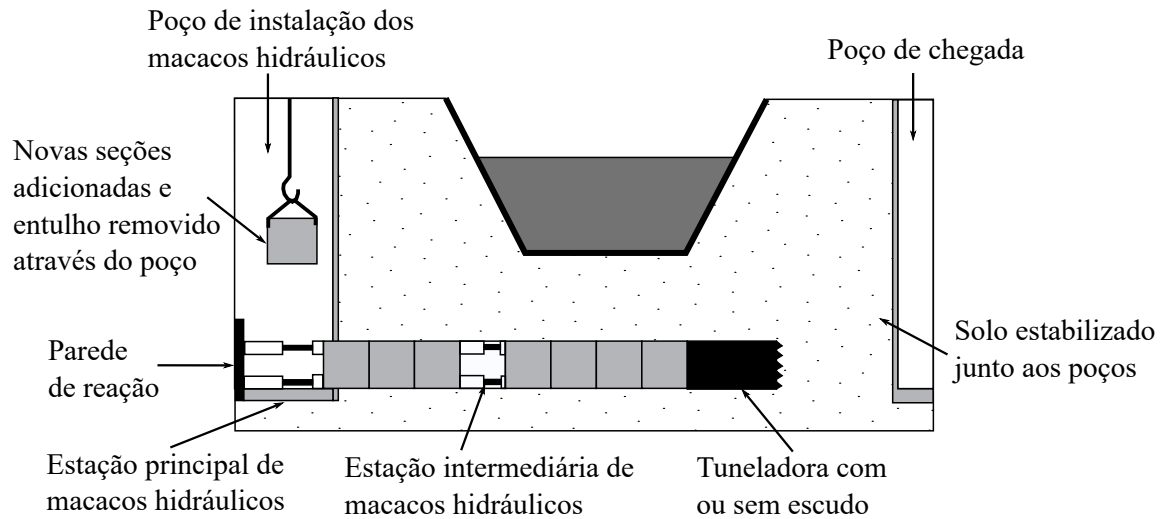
Ilustração do método de cravação de tubos sob um canal (adaptado de: Chapman, Metje e Stärk (2018, p. 227))
